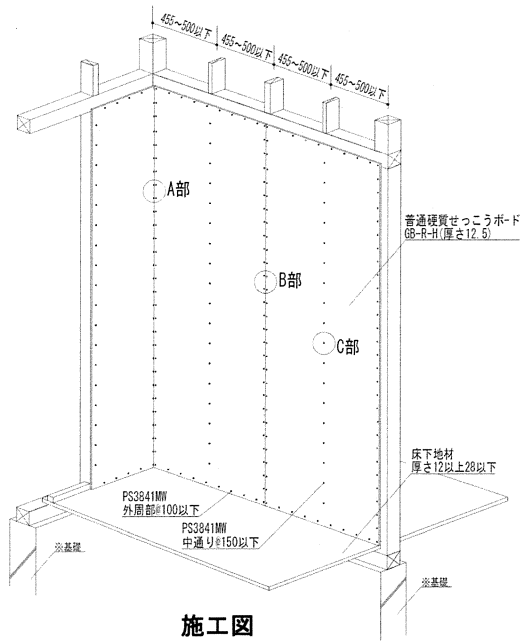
施工詳細図 : 縦継ぎ張りの場合 (寸法単位 : mm)
